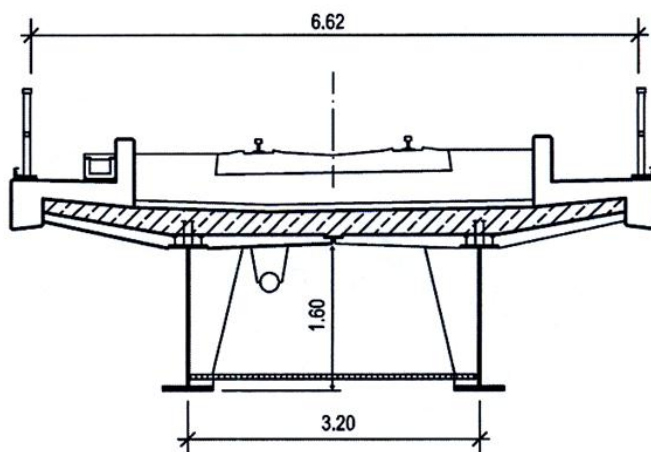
Пролетное сечение двухбалочного железнодорожного моста с монолитной железобетонной плитой на сварных балках несимметричного двутаврового сечения [13]
